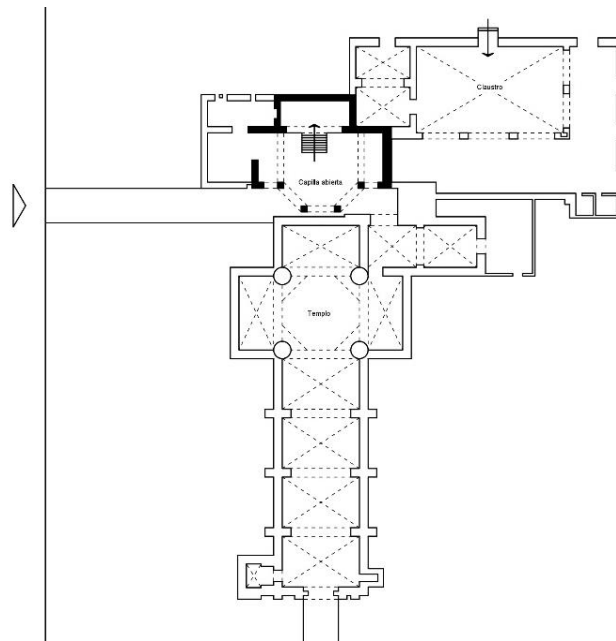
Planta Arquitectónica de la Capilla y del Templo
